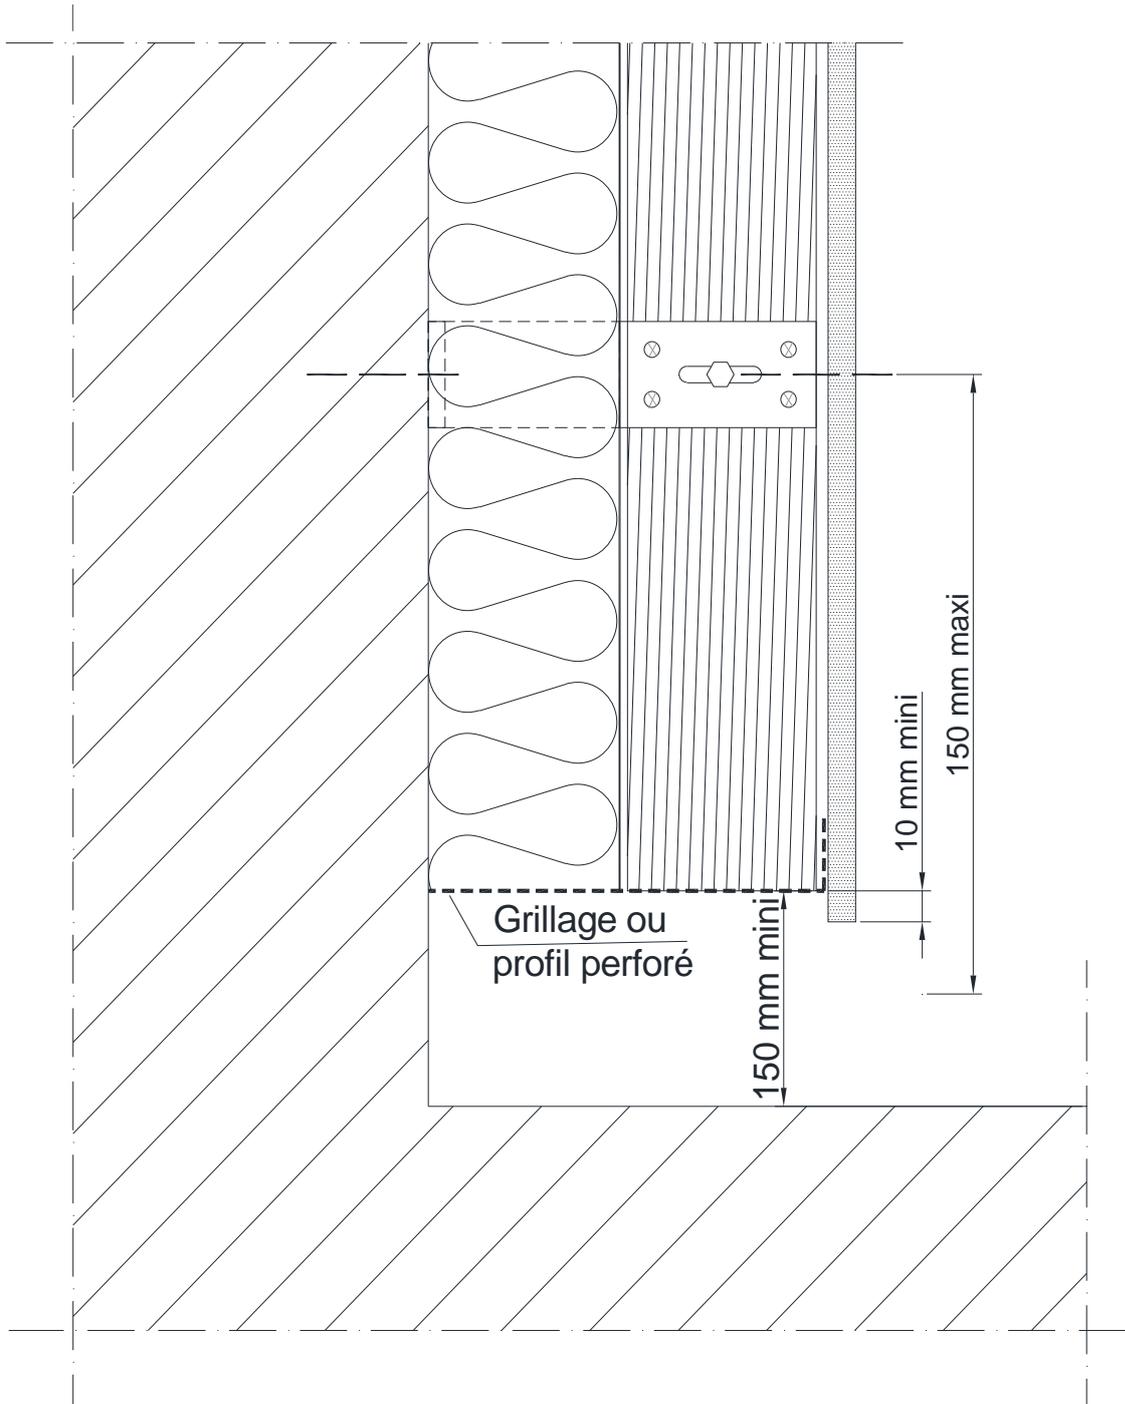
Arrêt horizontal sous balcon (Coupe verticale)
